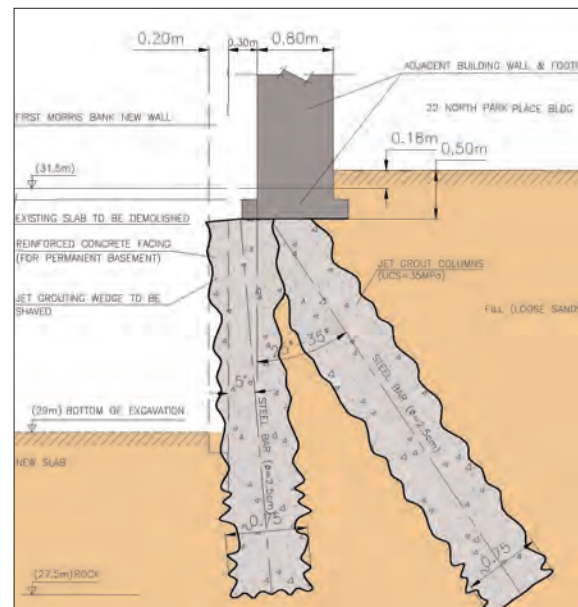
SECCIÓN TRANSVERSAL (A-A).
